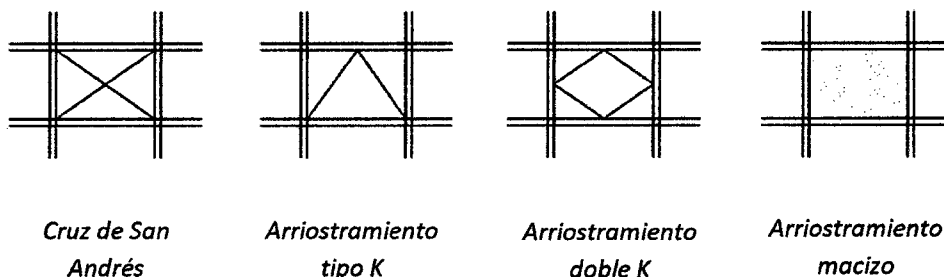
Tipos de arriostramientos en vigas y columnas.
